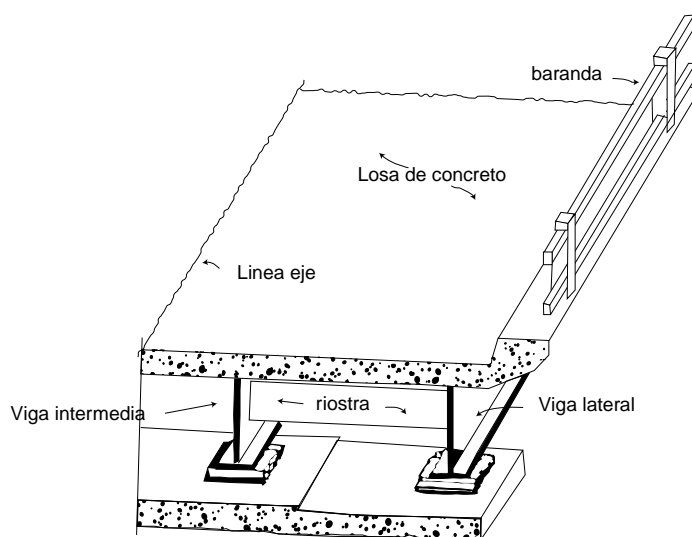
Partes de la superestructura de un puente de sección compuesta.
